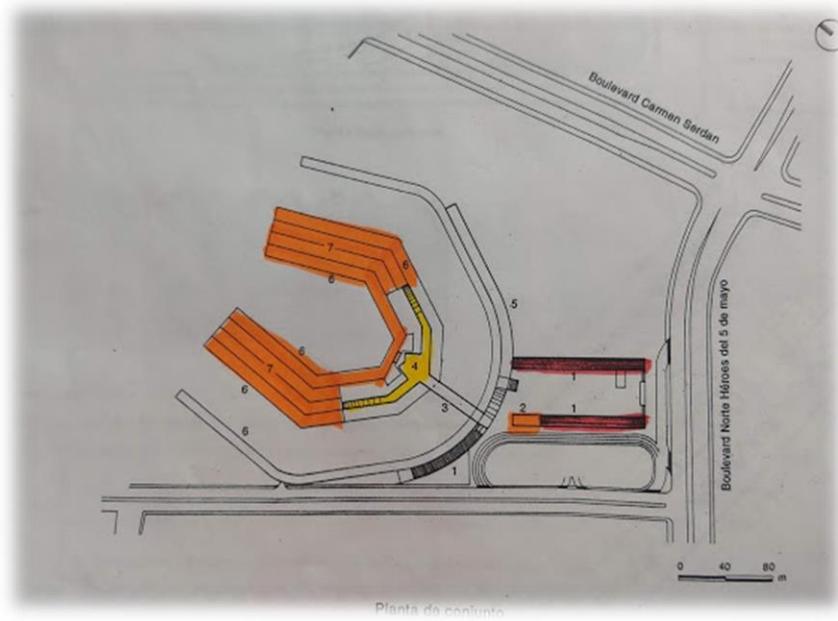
PLANTA DE CONJUNTO GENERAL
